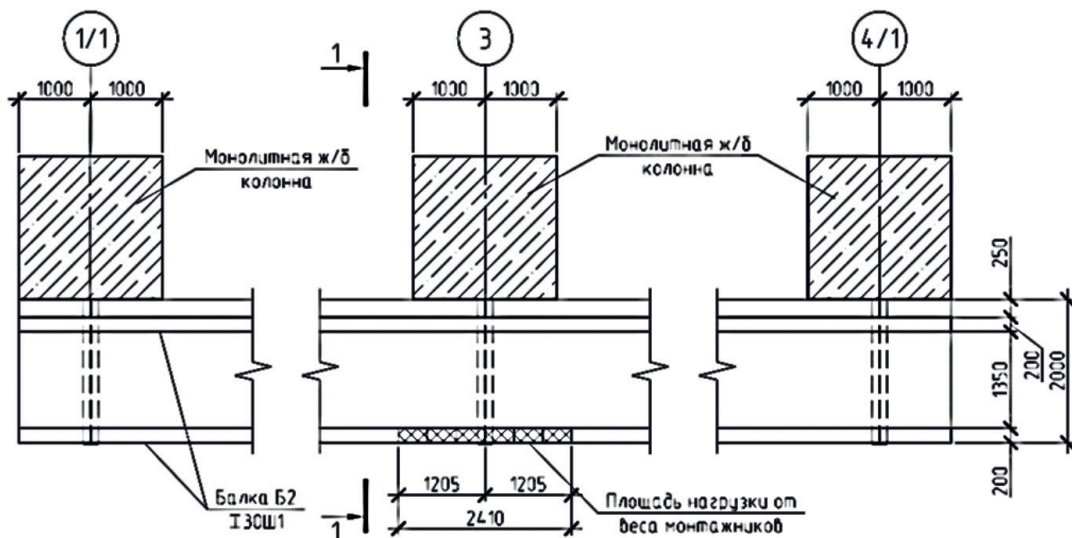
Схема расположения элементов площадки и нагрузки от веса монтажников
